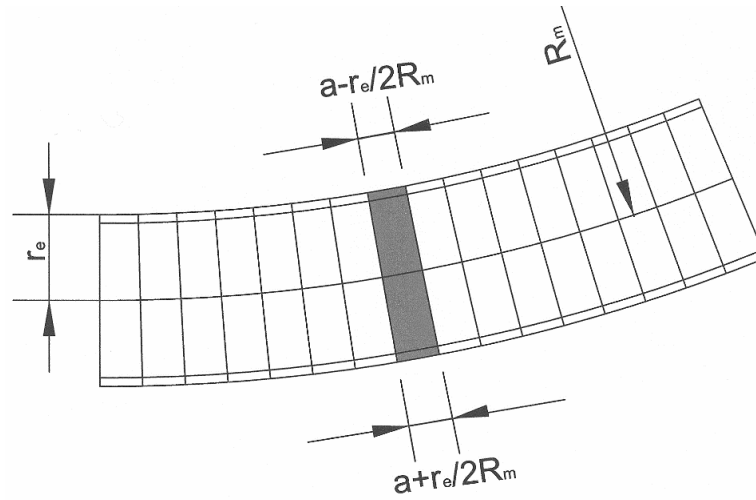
Geometria dell'anello di conchi prefabbricati, vista planimetrica in curva
